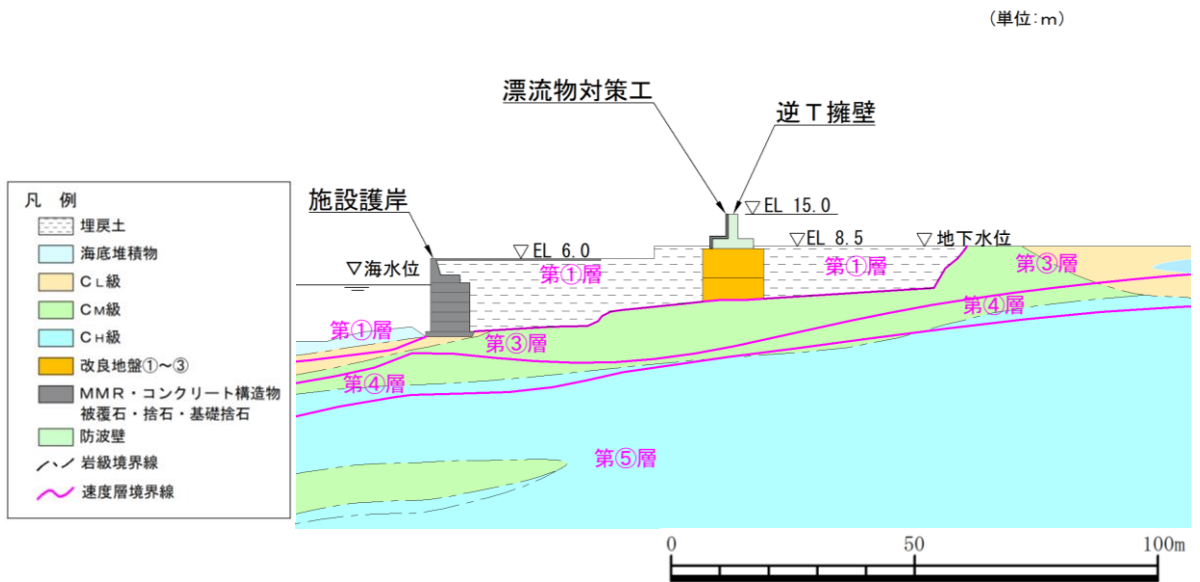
防波壁 (逆 T 擁壁) の横断面図 (⑥-⑥断面)
